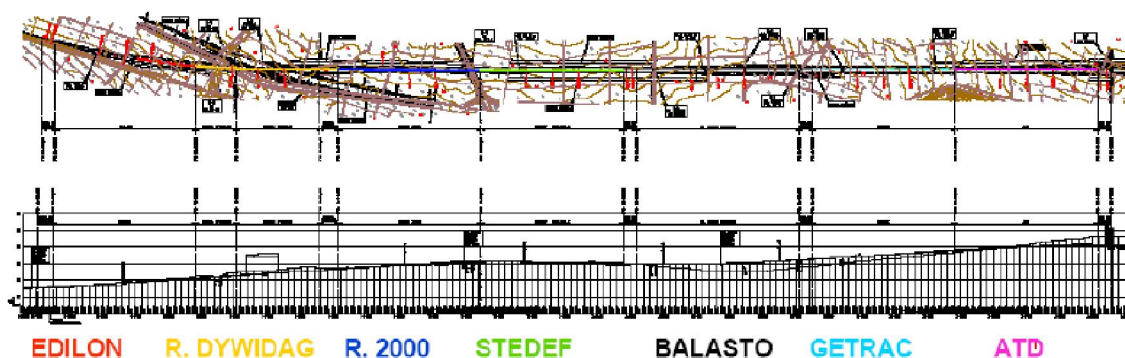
Planta i secció longitudinal del tram d'assaig, extret de [10].
